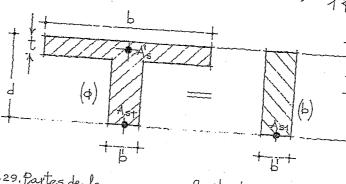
Partes de la loso trobajando en conjunto con la viga "t,"(c).
